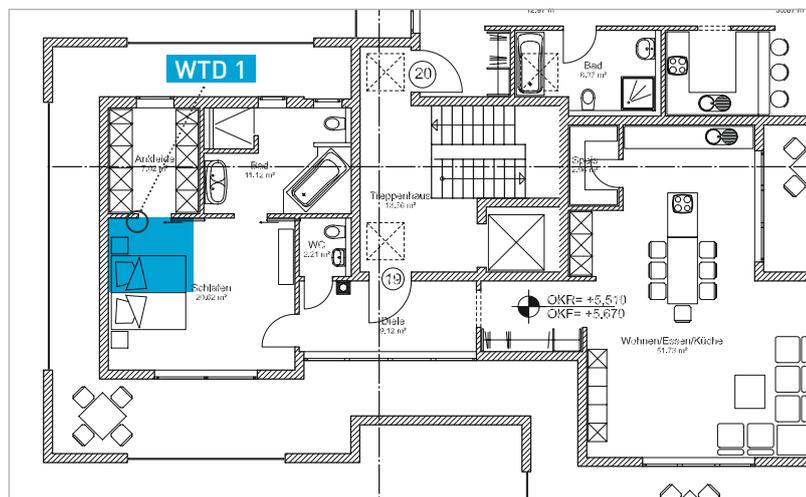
Wohnungstrenndecke Obergeschoss zu Staffelgeschoss
